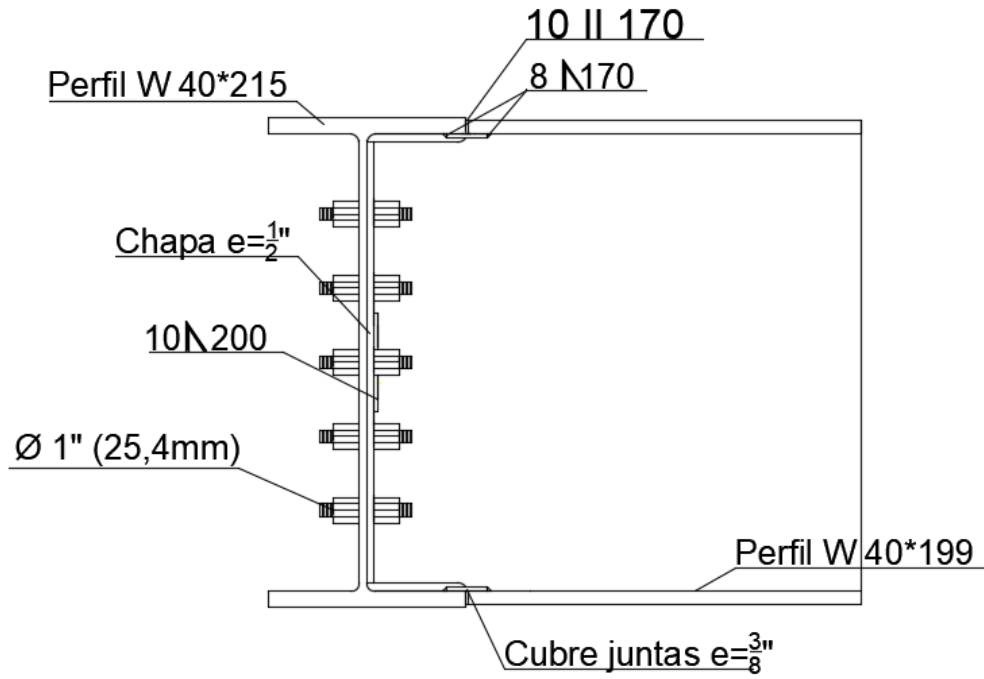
Detalle unión entre vigas transversales y longitudinales.
